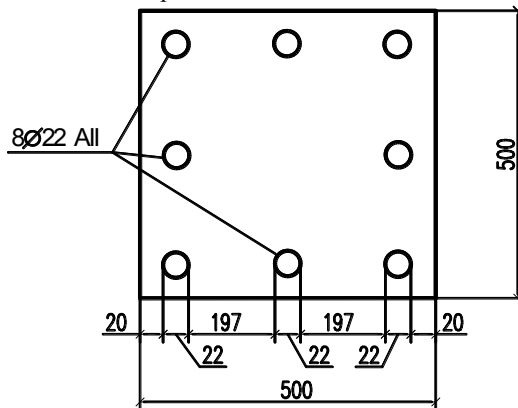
Схема розміщення арматури в перерізі колоні
